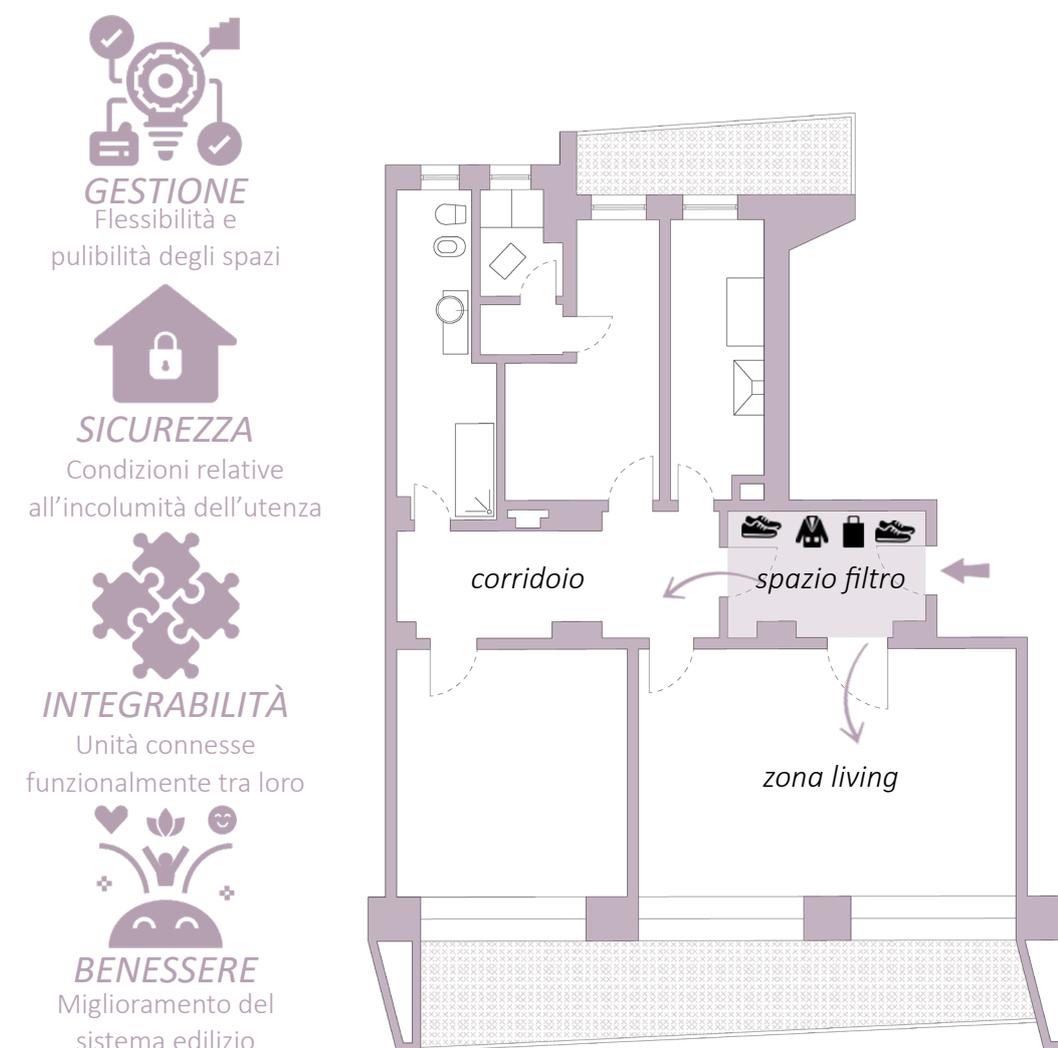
Rappresentazione planimetrica dell' ambiente ingresso-filtro.
